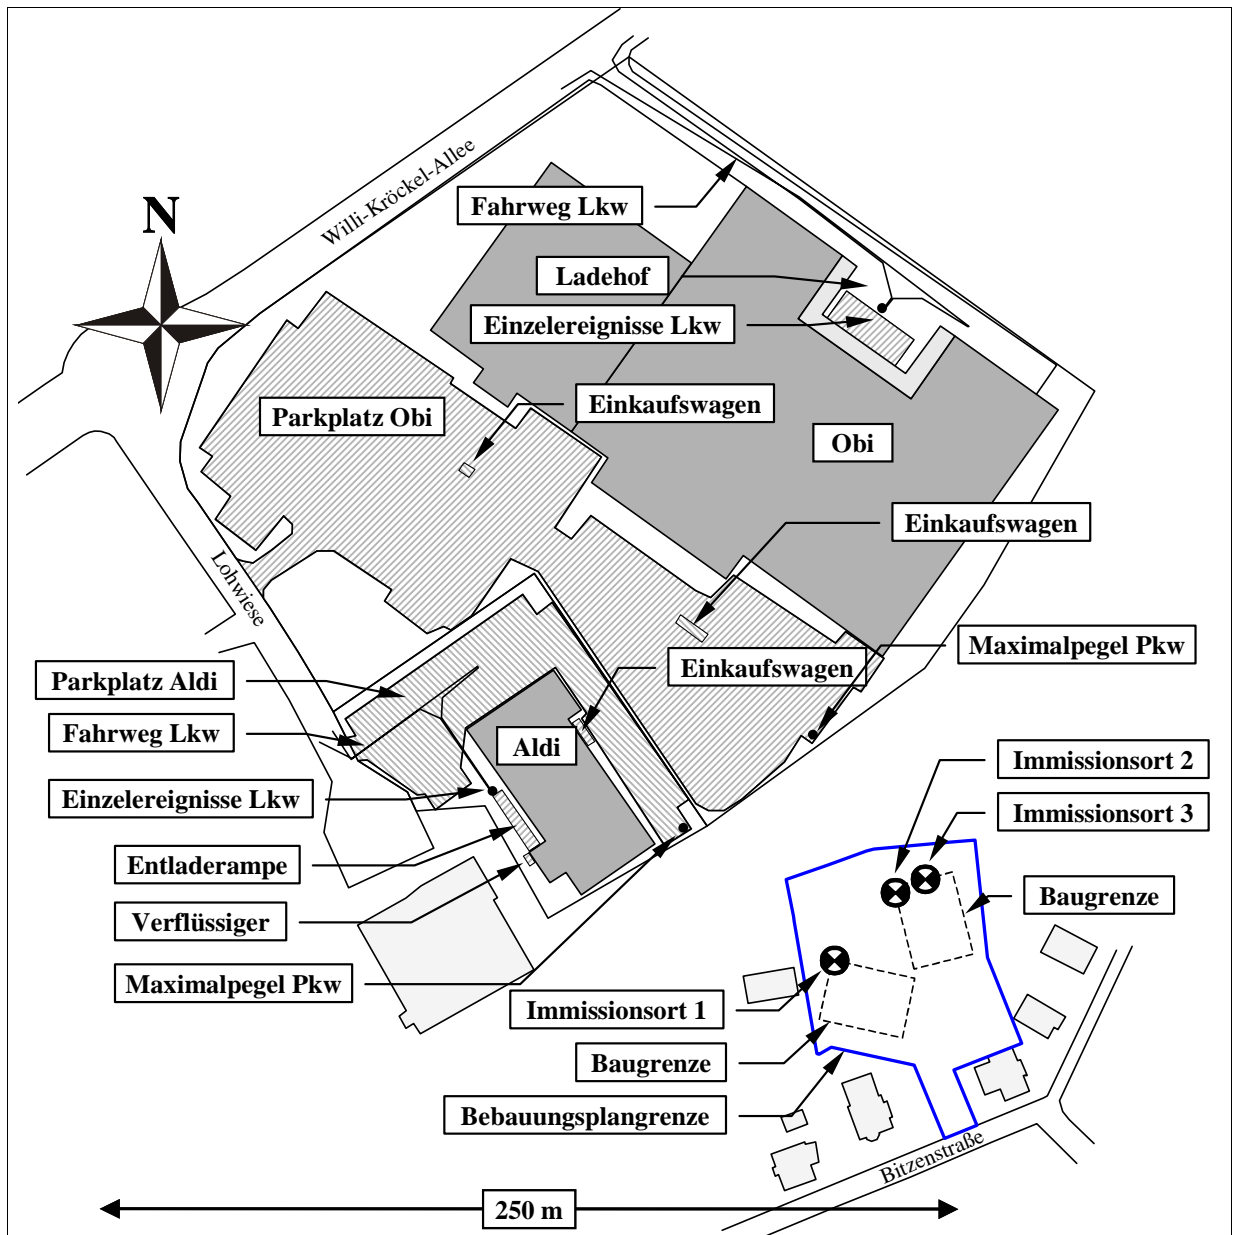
Lageplan mit Kennzeichnung der Schallquellen und der Immissionsorte.
